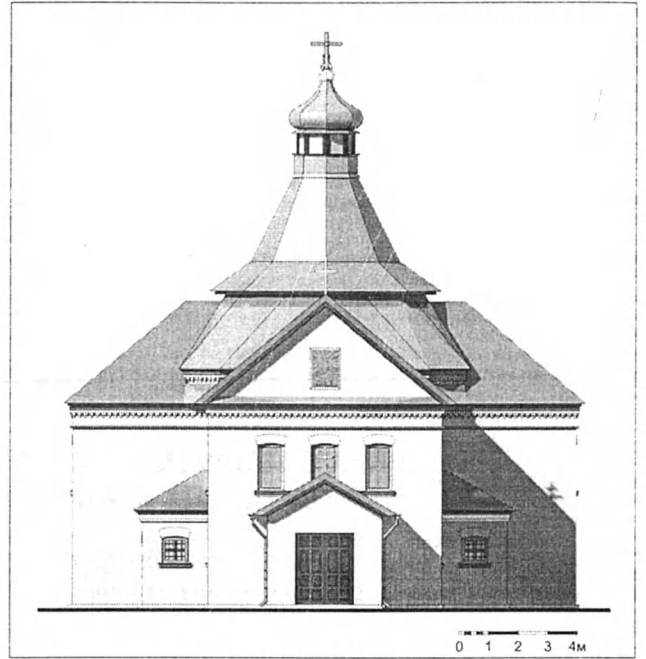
Головний фасад. Кресленик О. Тадеєвої.
